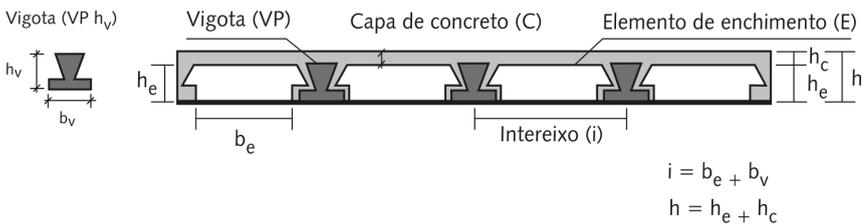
Lajes com vigotas de concreto protendido (LPh)
